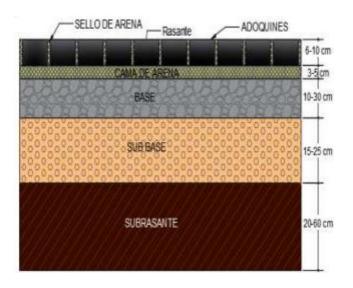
Estructura de un pavimento articulado. (Aysabucha, 2020)
